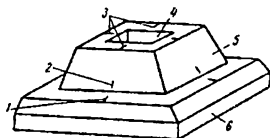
Схема ориентирных и установочных рисок на фундаменте и опорных башмаках колонны:
